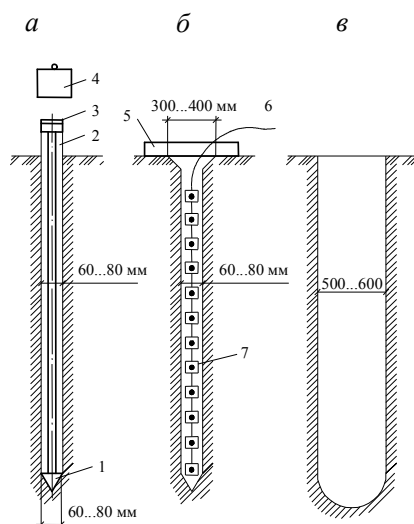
Схема пристрою свердловин енергією вибуху: а – розробка свердловини-шпуру; б – свердловина-шпур, підготовлена до вибуху; в – готова свердловина; 1 – обойма; 2 – бурова штанга; 3 – наголовник; 4 – молот; 5 – дерев'яний брус для підвіски зарядів; 6 – детонувальний шнур; 7 – заряд ВР
